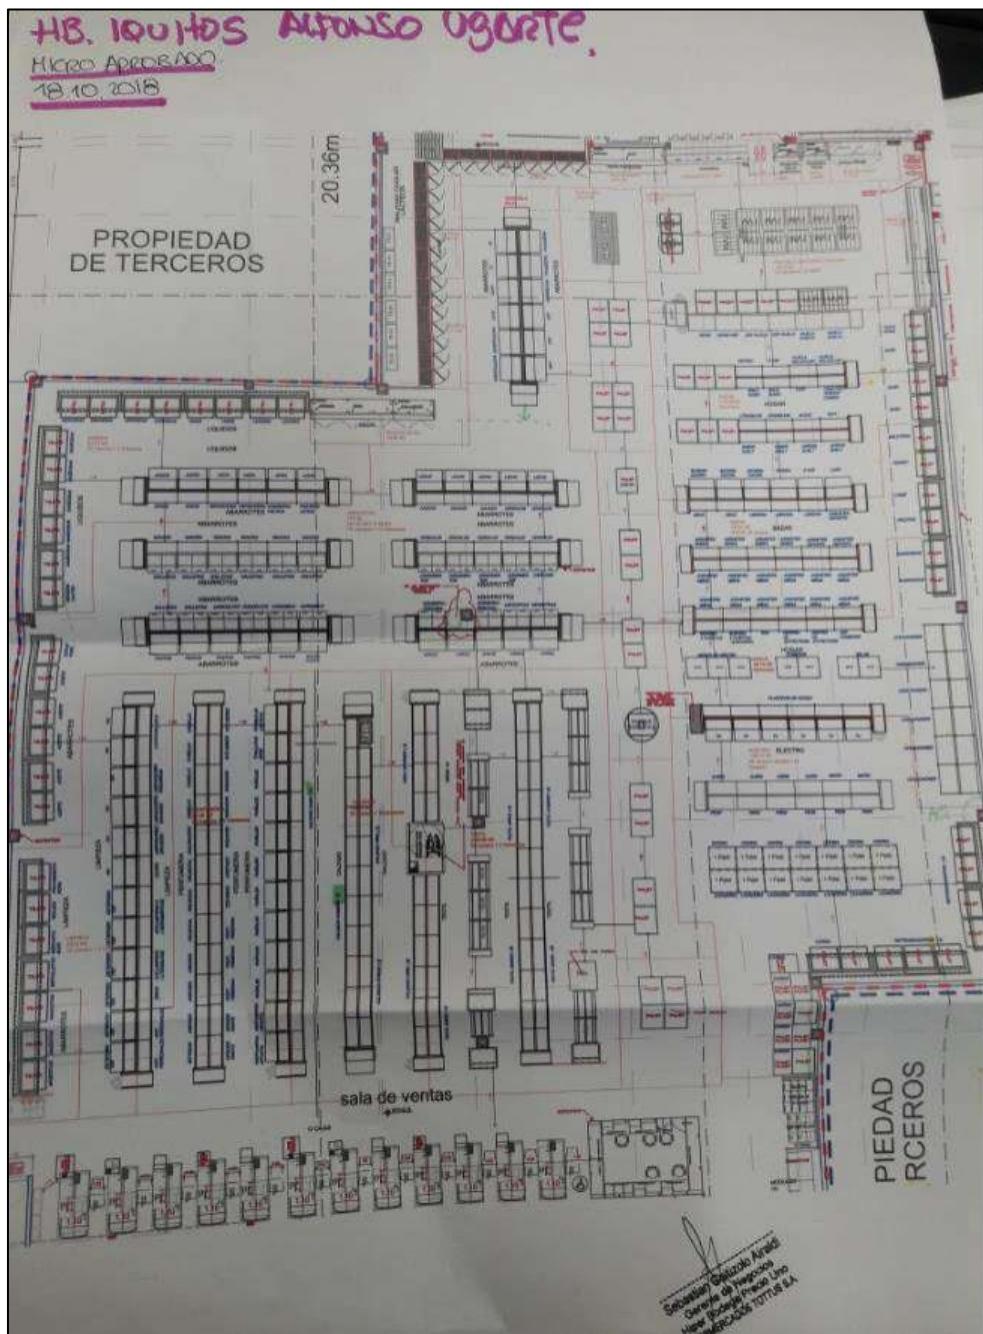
Planta Macro Layout y Micro Layout Aprobado
